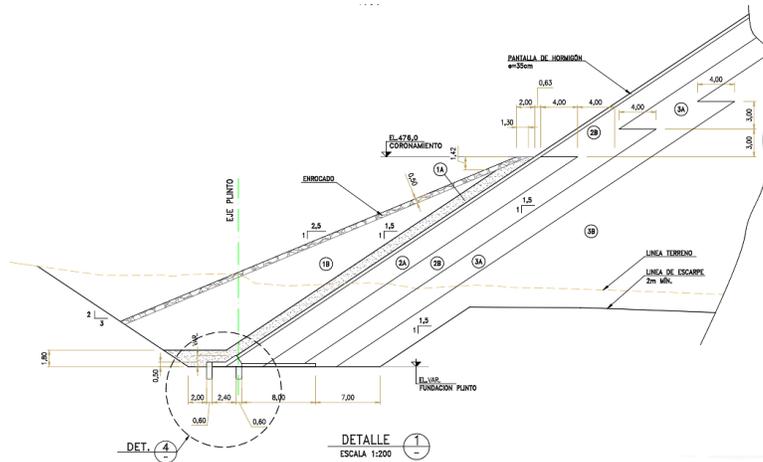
Plano Muro Principal, Detalle Plinto.
